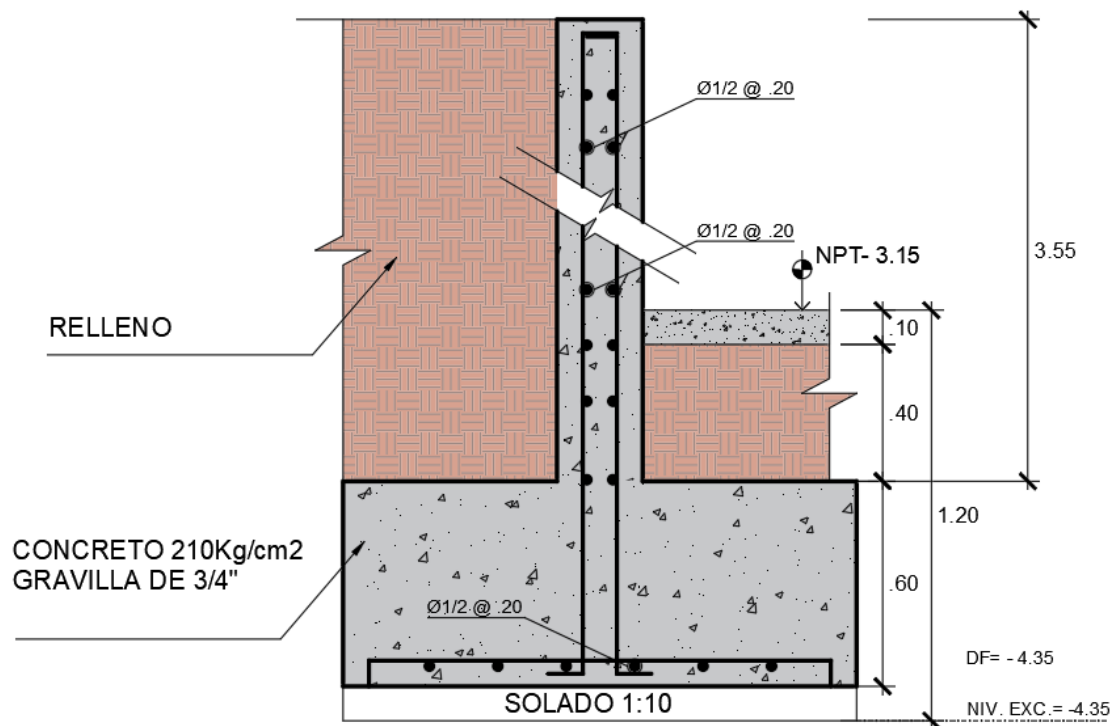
Detalle constructivo de muro de contención. Elaboración propia.
